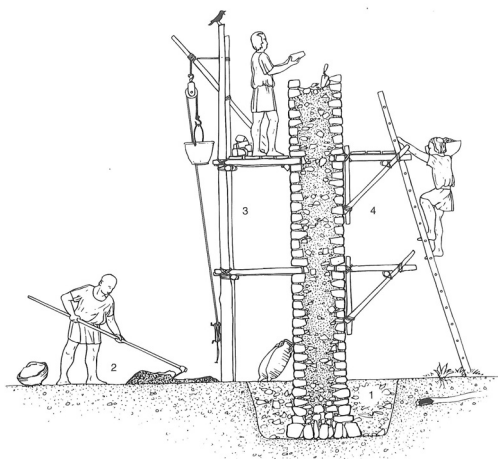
Ejemplo de andamio empotrado con sistema rampante, de pértigas y almojayas (izq.) o basculas (drc.) (Adam)
